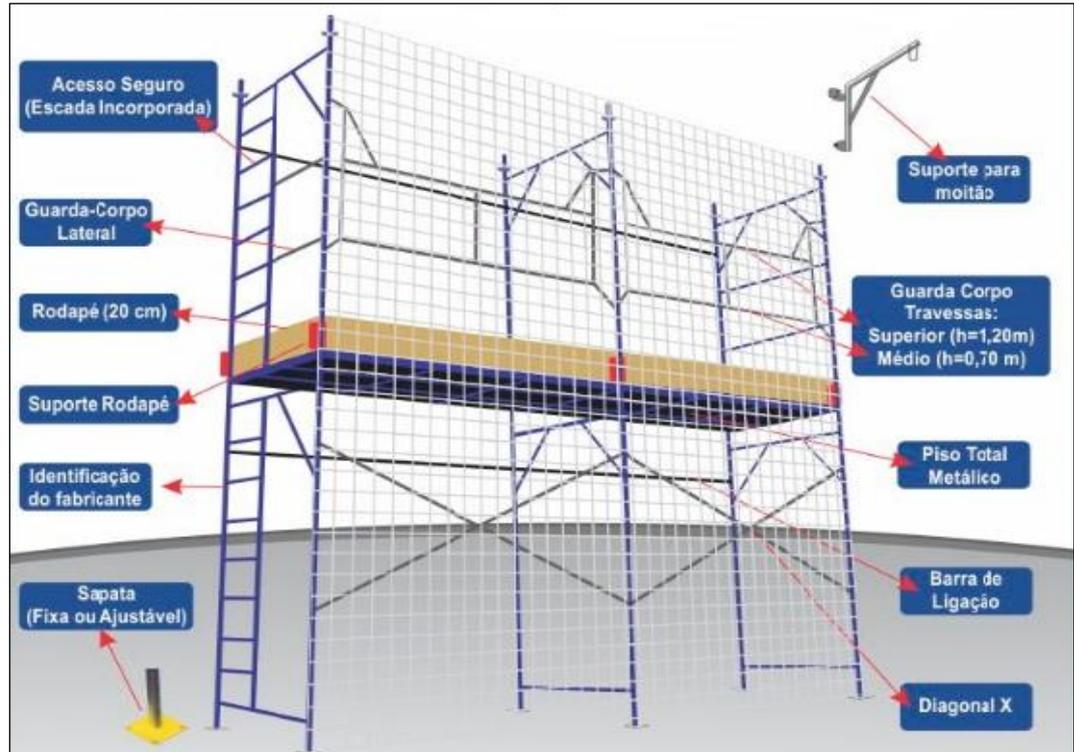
Proteções coletivas em andaime tipo fachadeiro.
